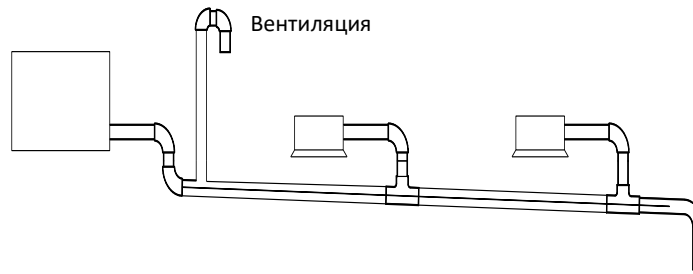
Вентиляционные отверстия дренажного трубопровода
